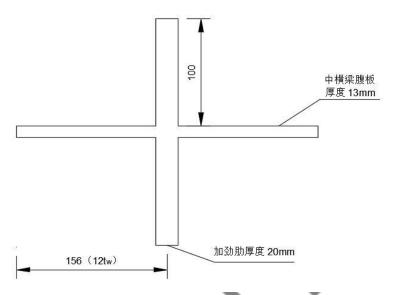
中横梁加劲肋承压面积示意图(单位: mm)
